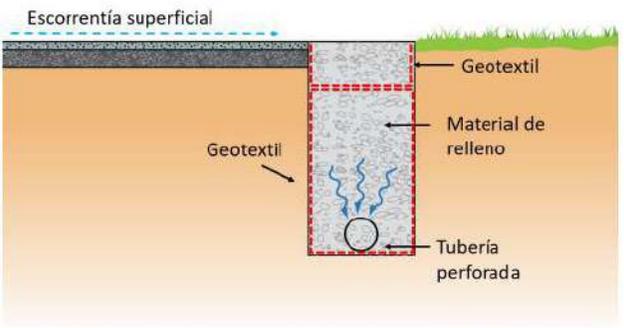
Esquema de un dren filtrante. Fuente: Adaptado de NHBC Foundation (2010).
